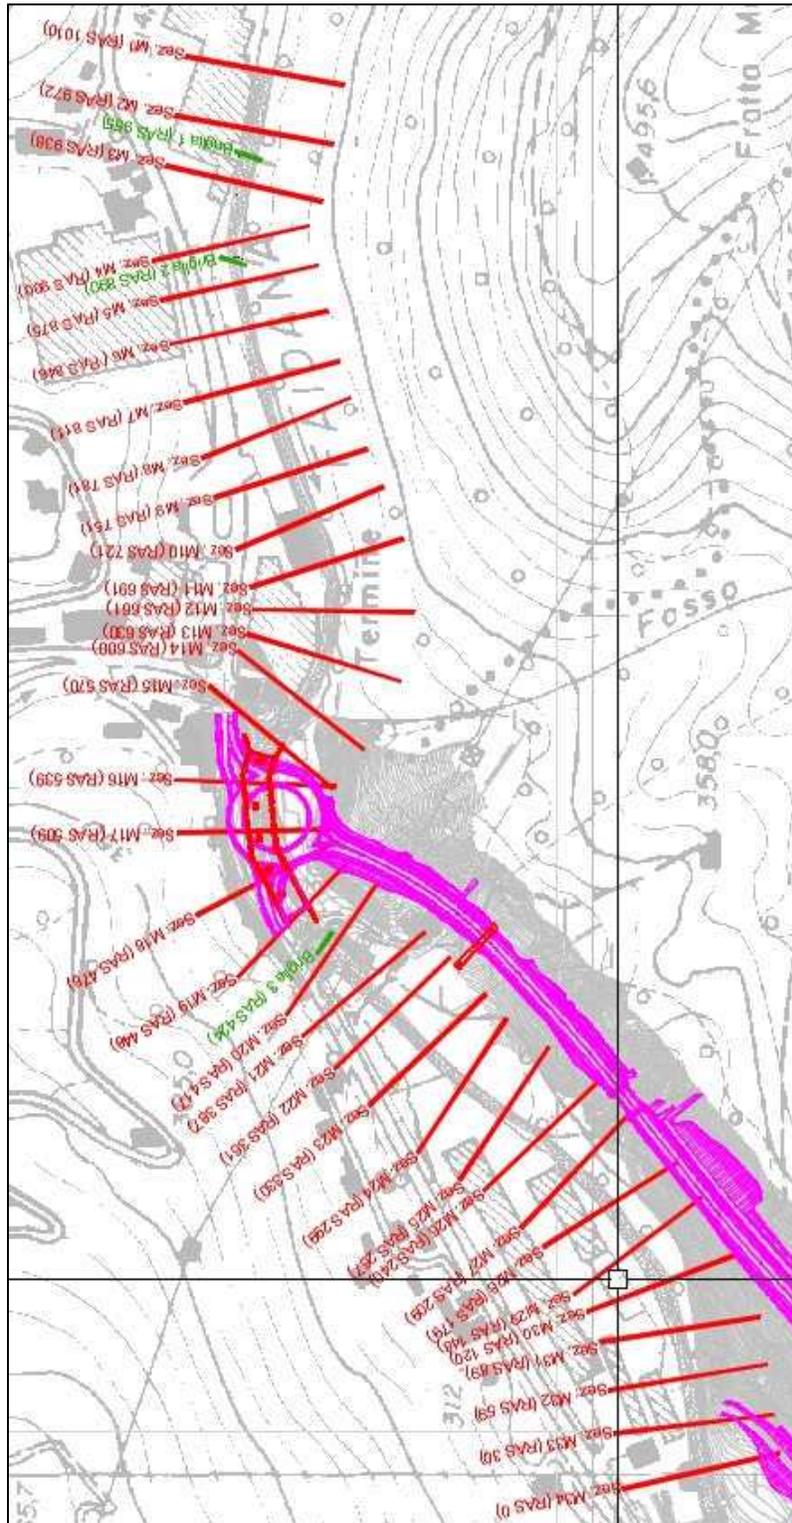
Inalveazione Faidana - OP3-070 - Planimetria tratto analizzato e indicazione sezioni RAS
